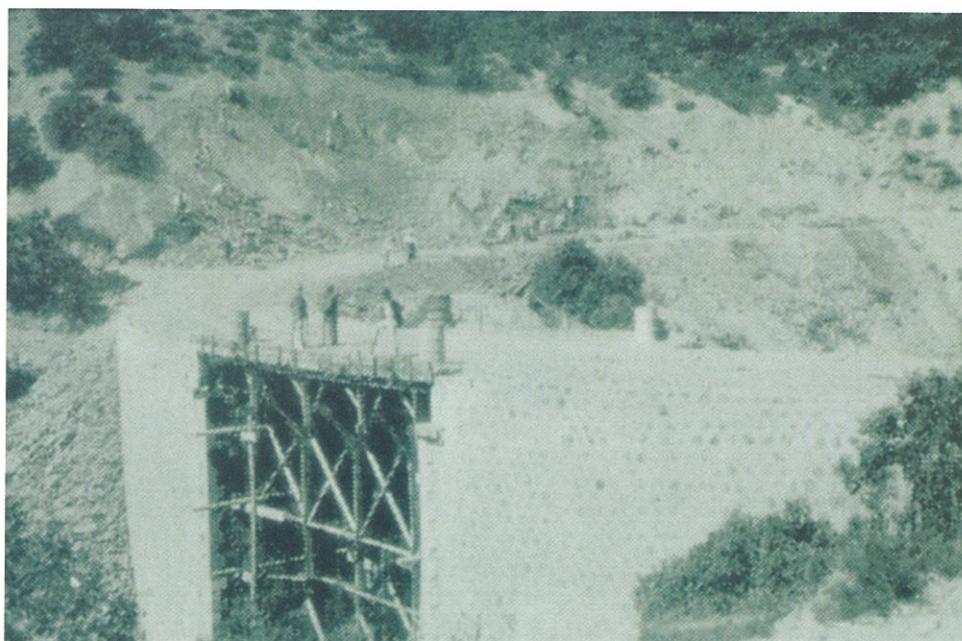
Puente en construcción en el tramo central de la carretera Tetuán-Melilla.
